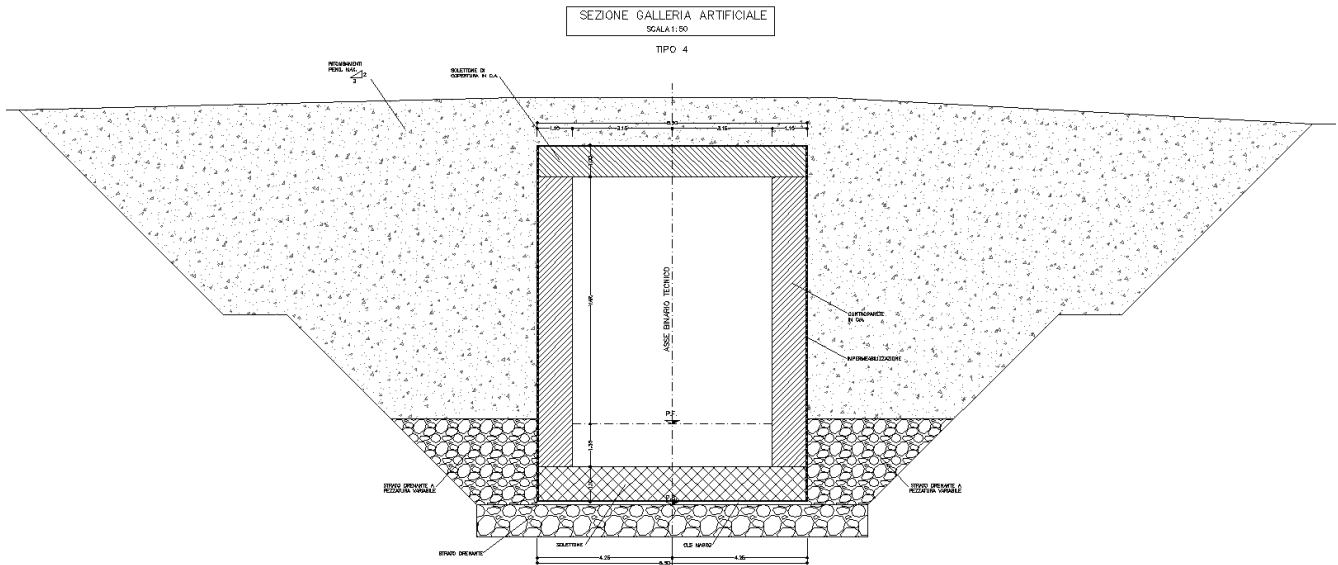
Galleria artificiale “Drenante” (sezione tipo “4”)
